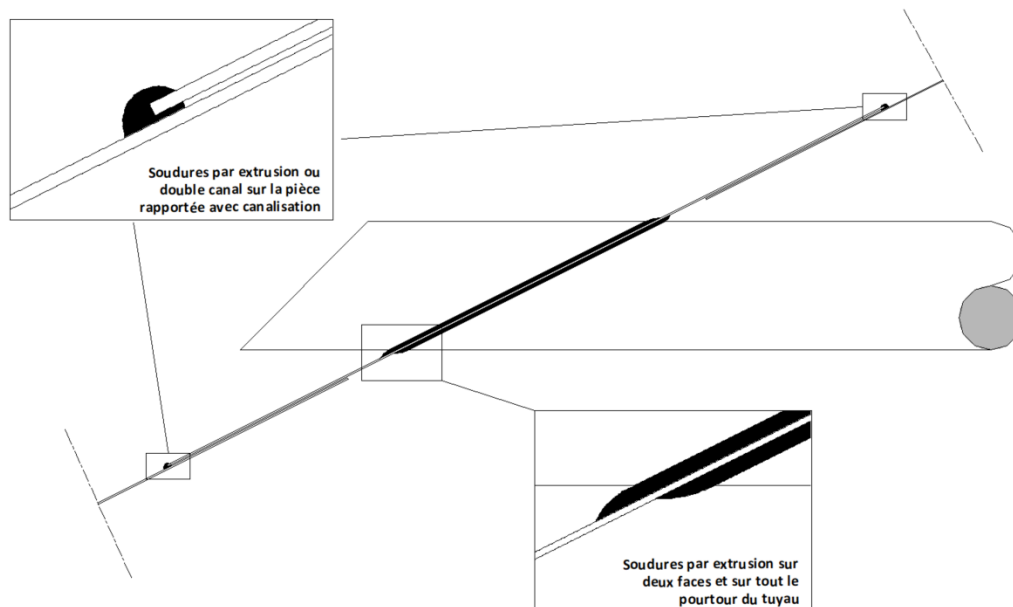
Principe de soudure de canalisation traversant la géomembrane
